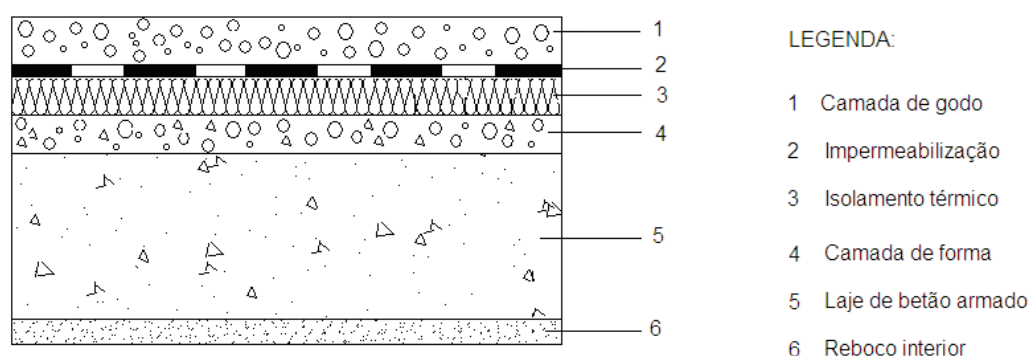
Pormenor construtivo da cobertura horizontal em terraço, sem barreira pára-vapor.
